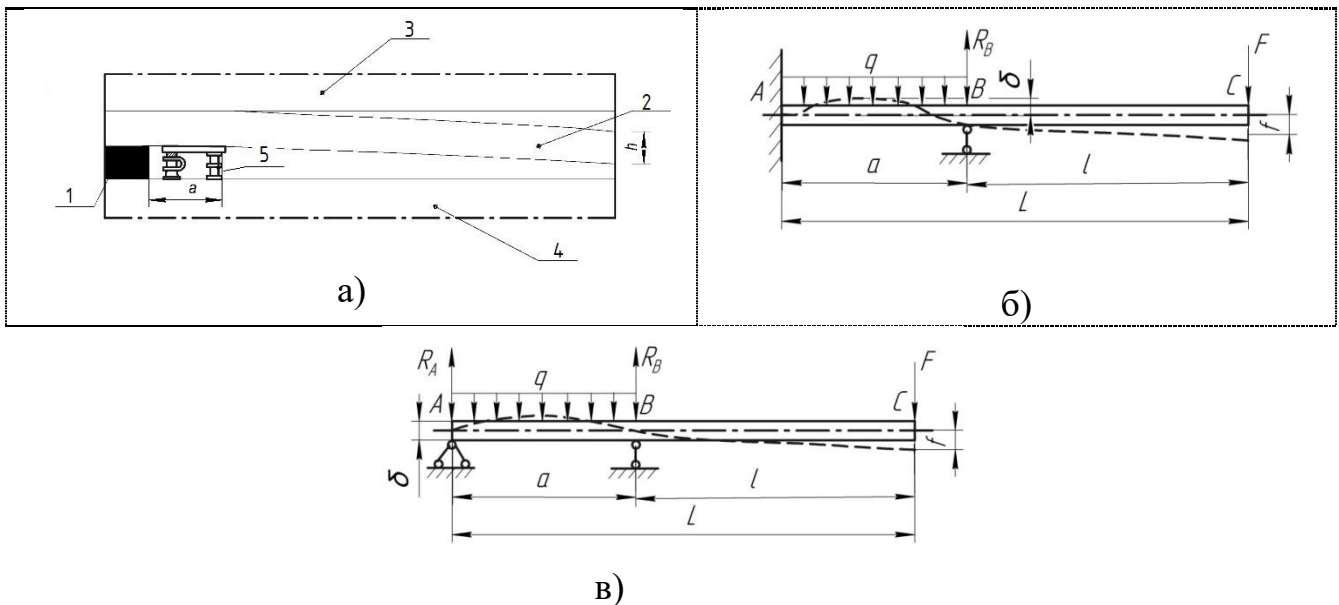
Расчетная схема к определению устойчивости расслоившихся пород кровли разрабатываемого угольного пласта:
